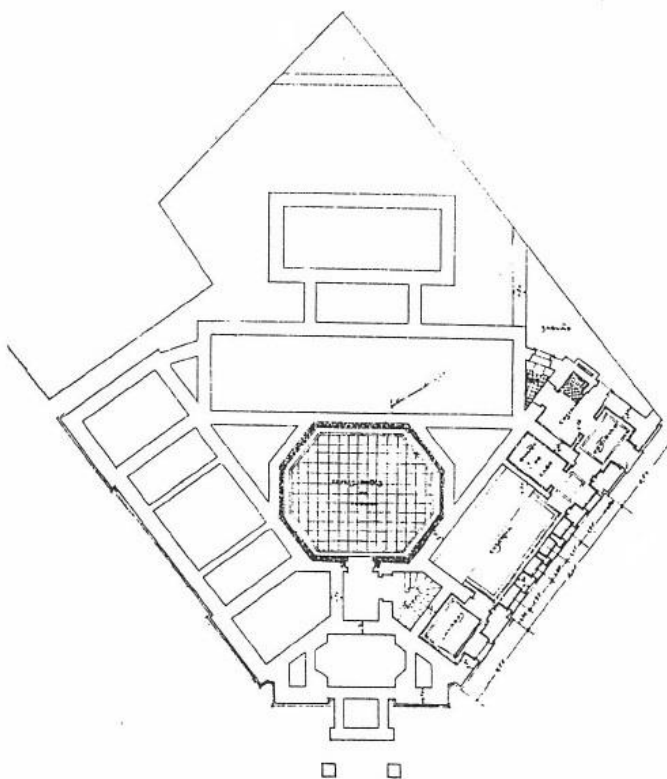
Planta do piso semienterrado da agência de Vila Real.
